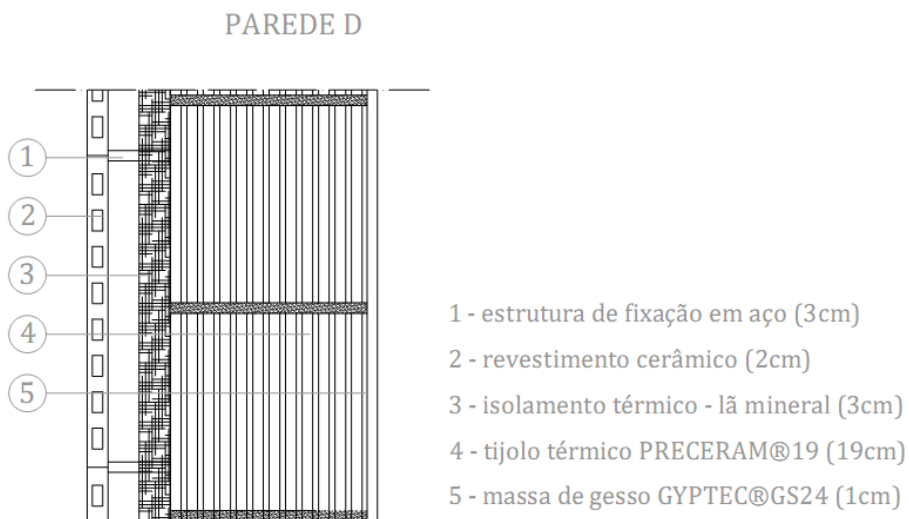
Solução de fachada ventilada com revestimento cerâmico [Parede D] (espessura: 0,28m)
